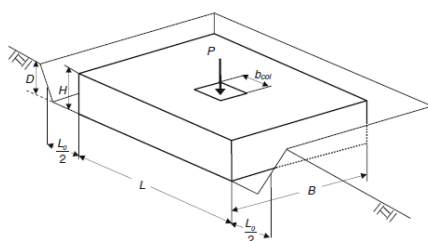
Modelo de cálculo zapata. Camp et al. [149]
